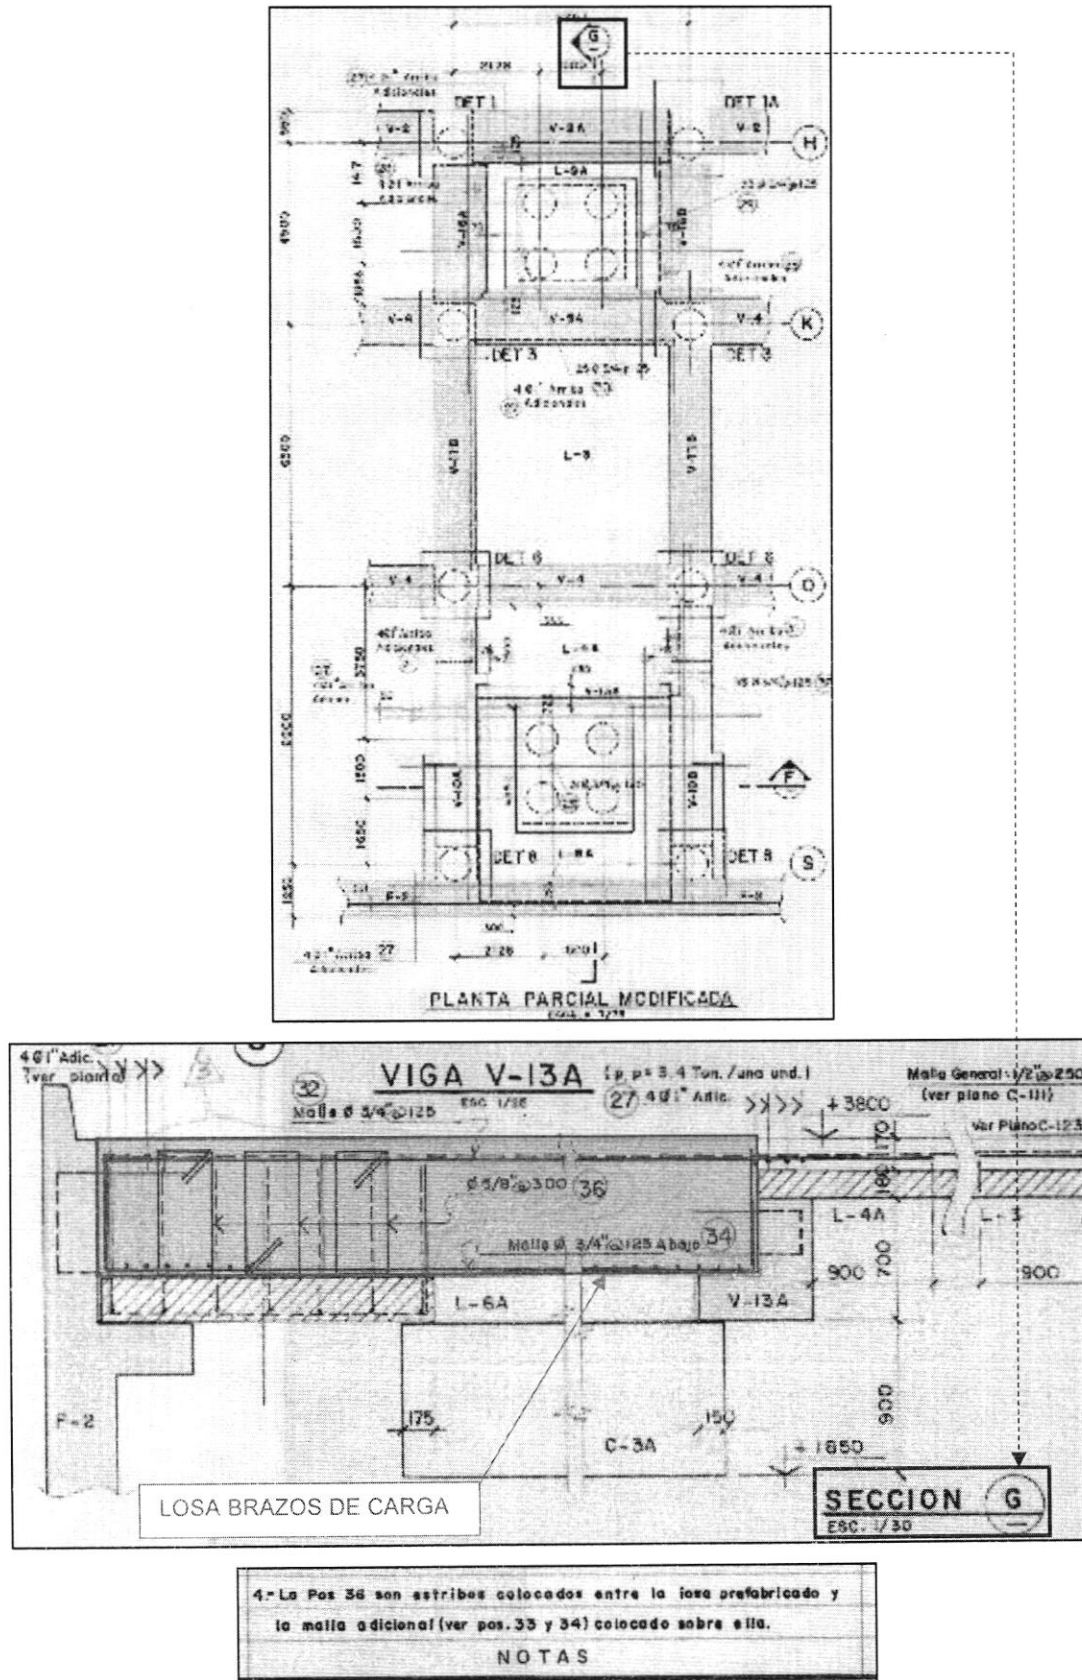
Detalle del armado de la losa en la zona reforzada con pilotes
